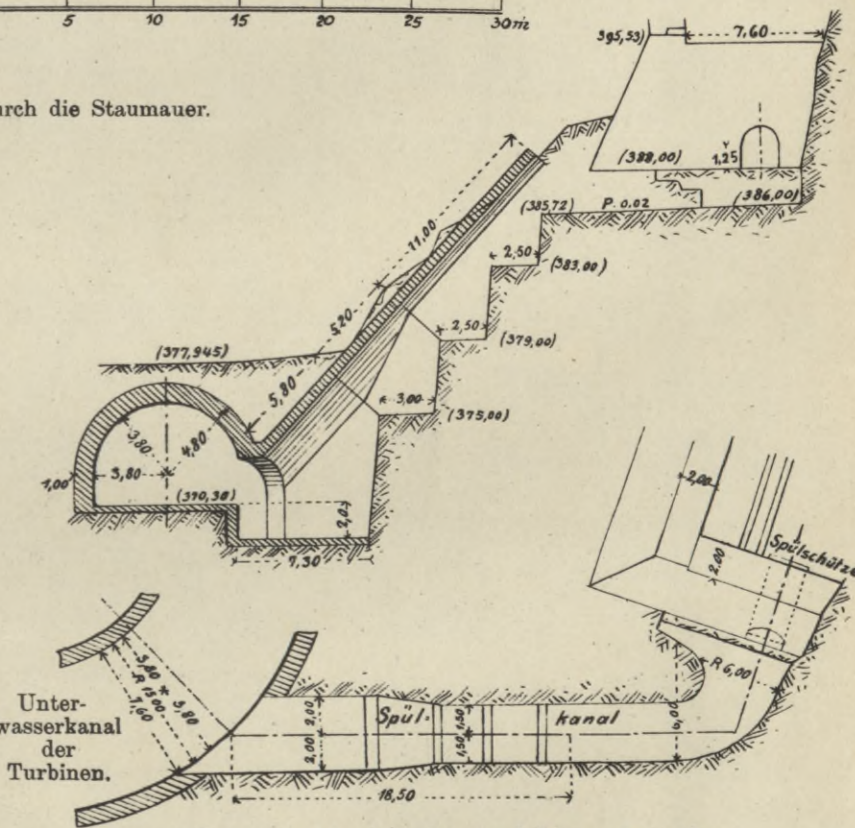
Grundriss und Schnitt a-b des Sturzbettes.
